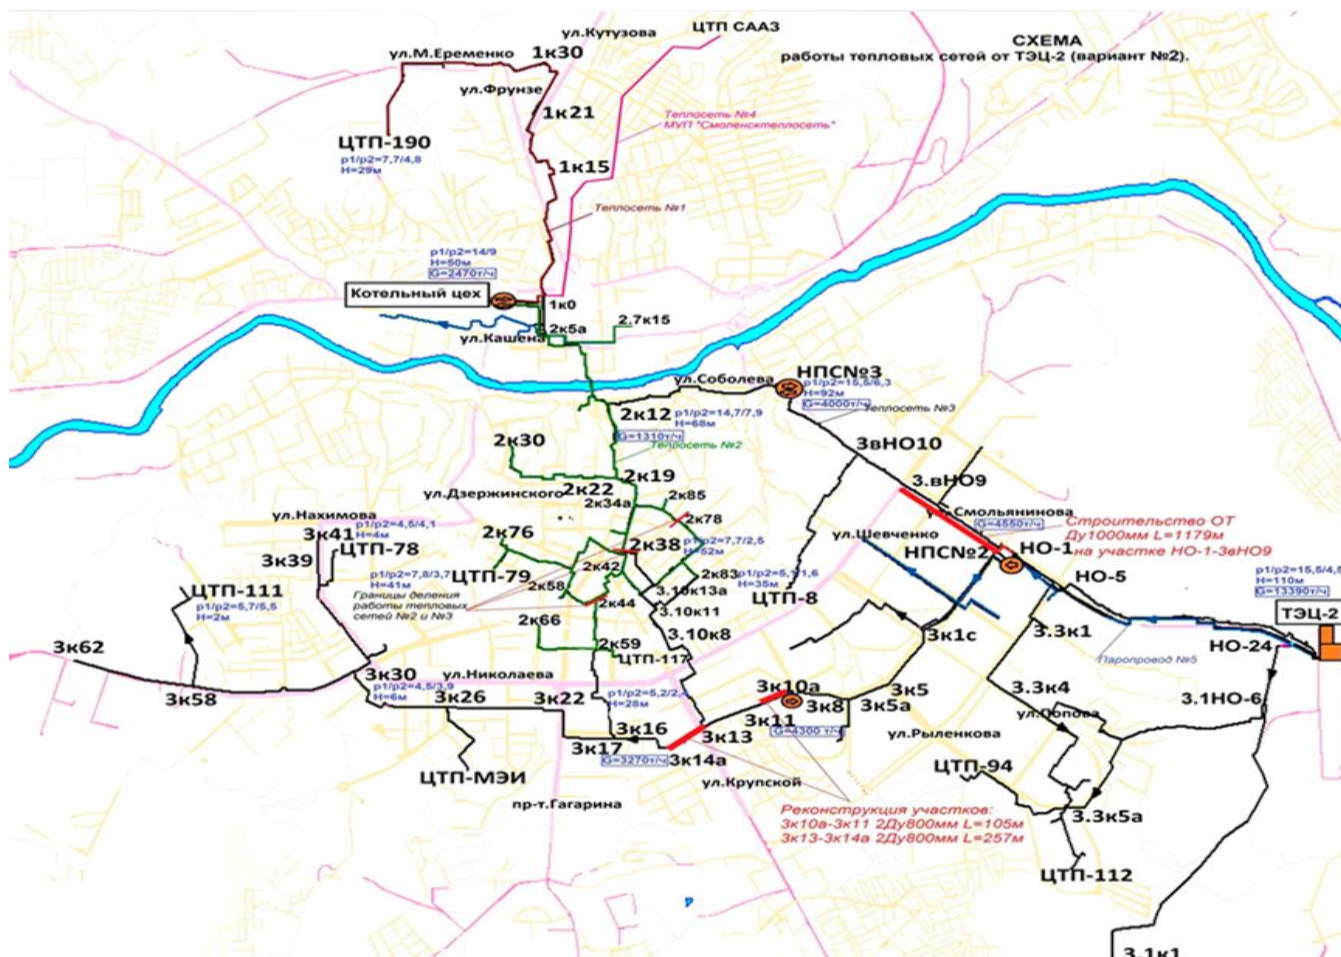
Схема теплоснабжения после перевода тепловой нагрузки с котельного цеха на Смоленскую ТЭЦ-2
